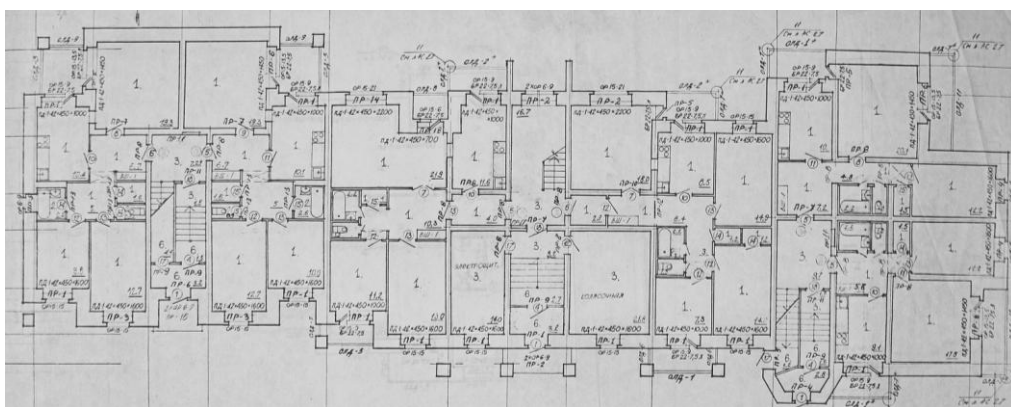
Чертеж плана второго этажа жилого дома по ул. Мира, д. 158.
